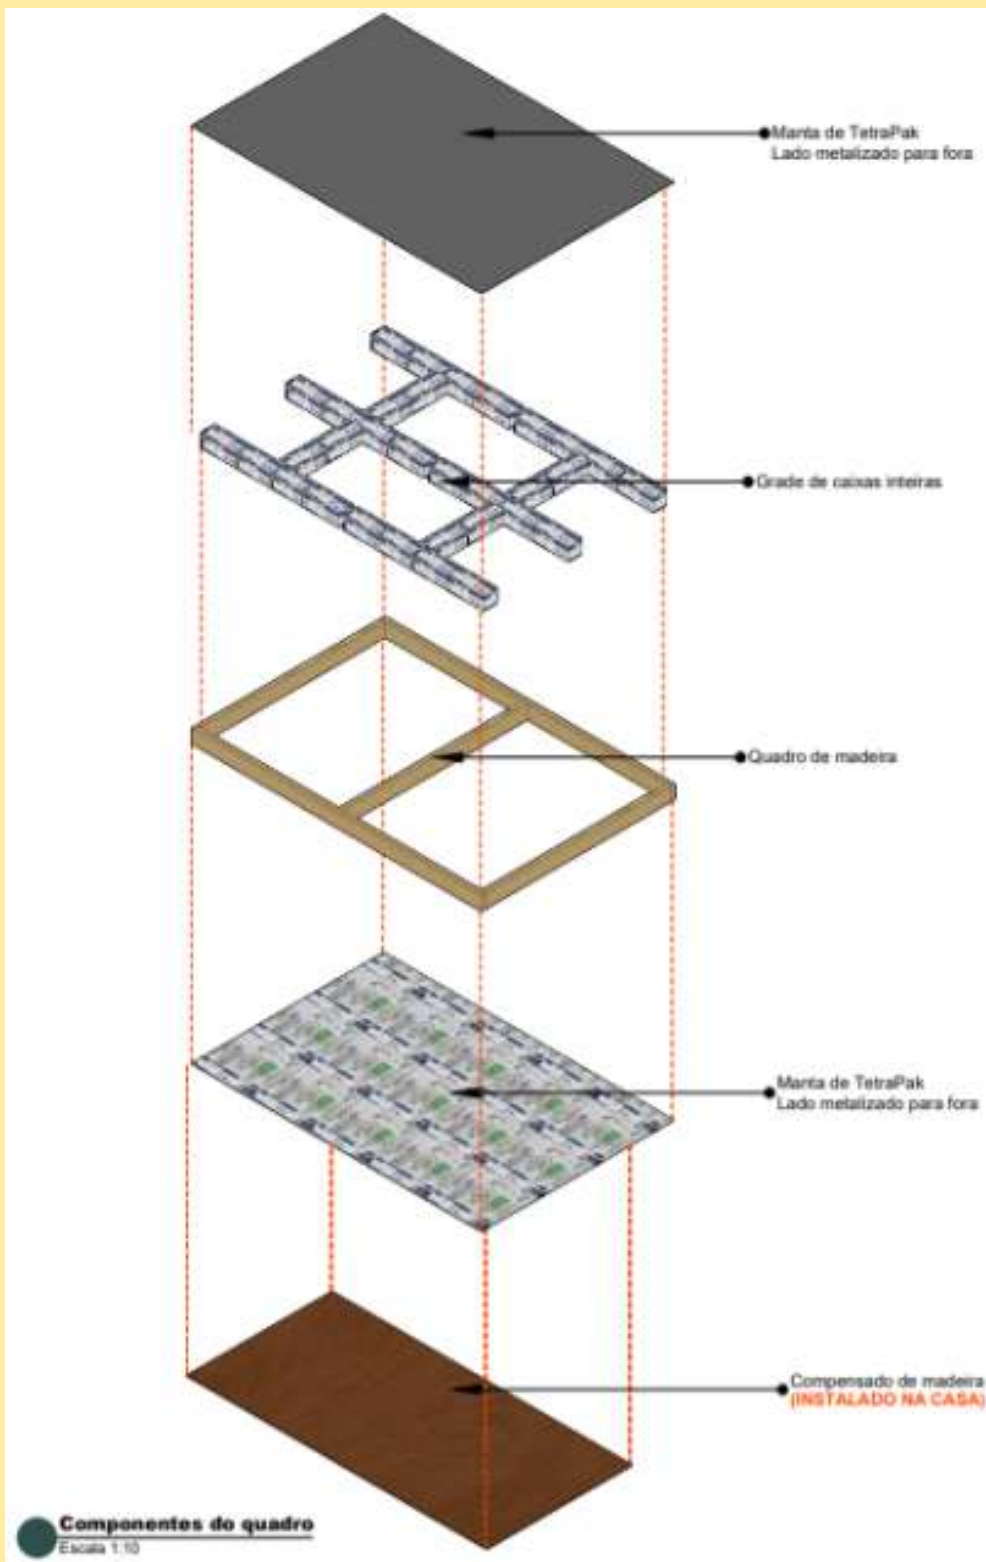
Estudos do primeiro dispositivo e fases da construção . Acervo dos autores, 2021.
